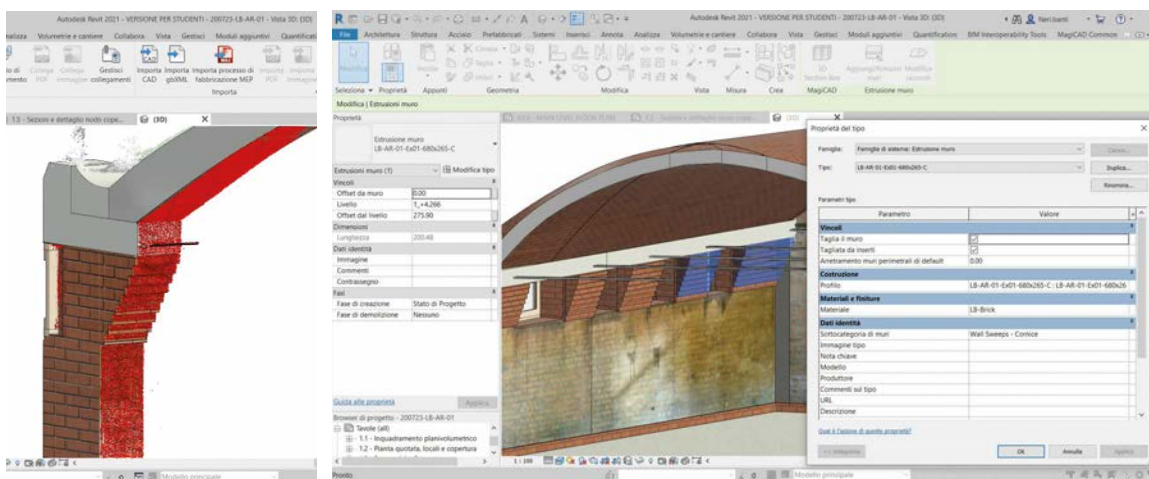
| Sección del modelo BIM destacando la faja de ladrillo en la parte superior de los muros exteriores. | Sezione del modello BIM con in evidenza la fascia in laterizio nella parte superiore delle murature esterne.
